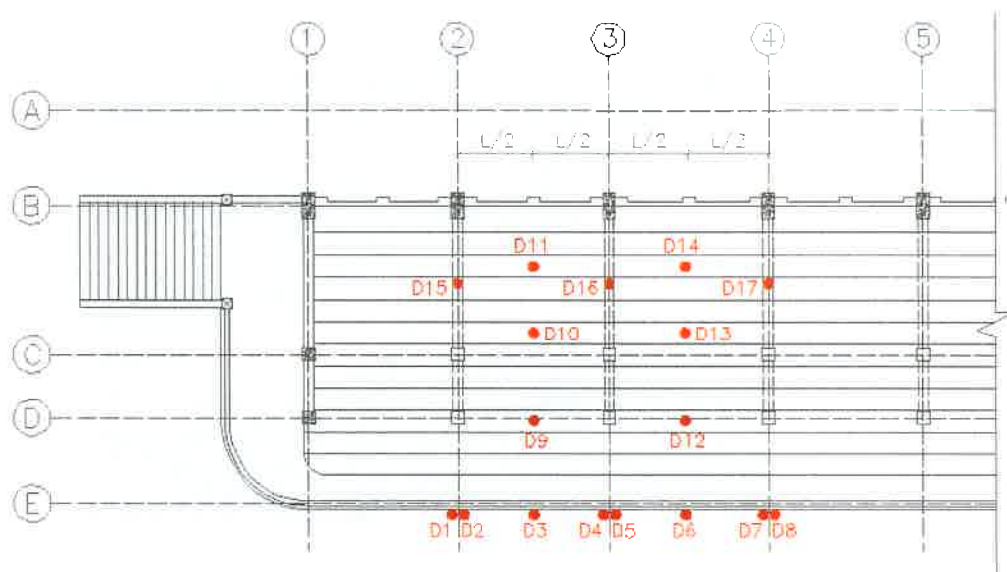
Desenho esquemático em planta do posicionamento da instrumentação instalada nos elementos estruturais.
